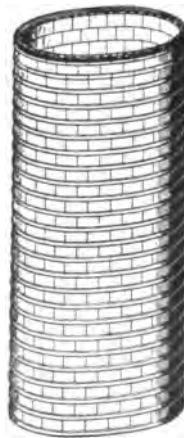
Runde Silozelle aus Eisenbeton (Mauerwerk).
